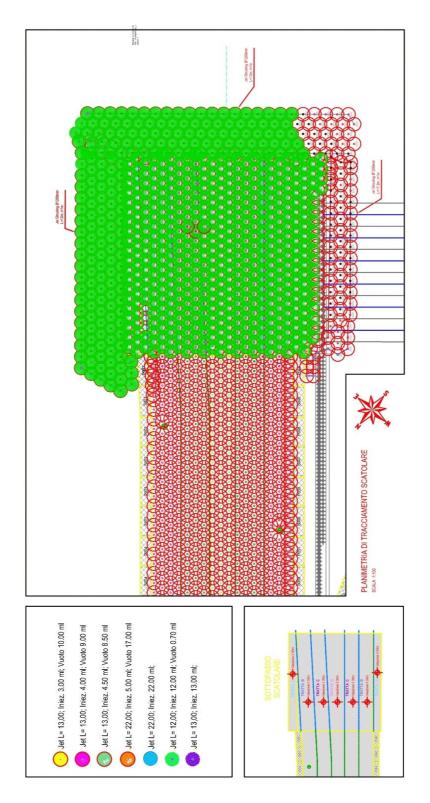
Galleria artificiale Fornaci II – Planimetria 2 di 2 – Tampone di fondo - Trattamento con Jet-grouting realizzato (Da As-Built)
